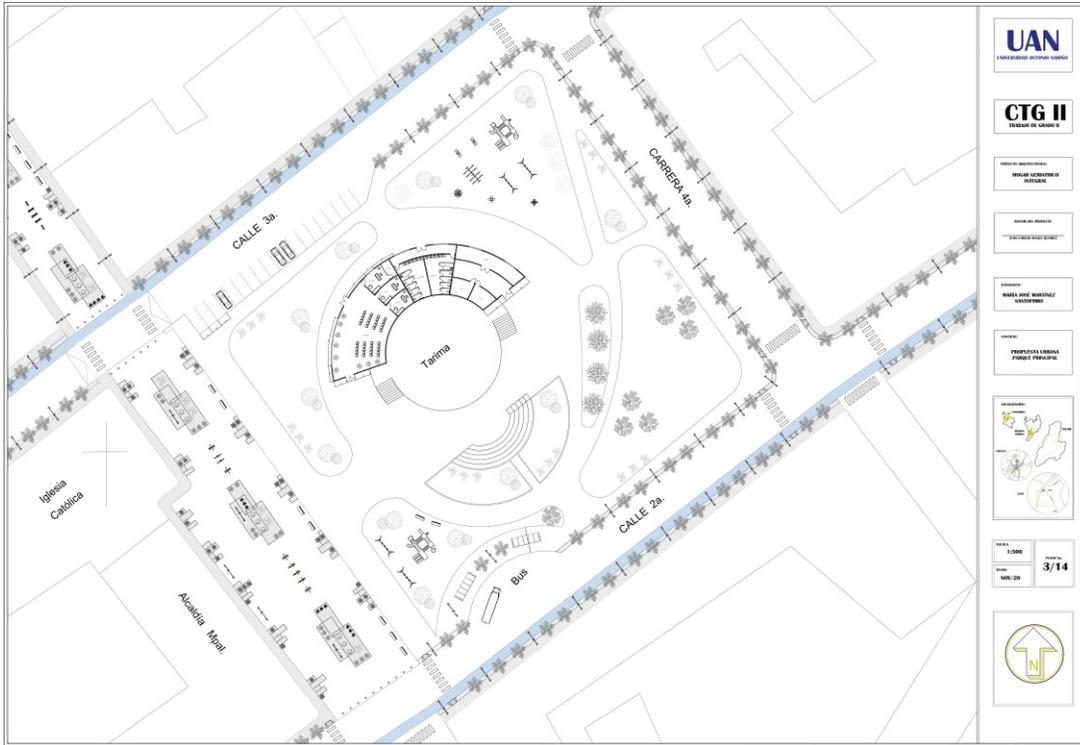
Planimetría Parque Principal. Fuente. Autoría Propia.
